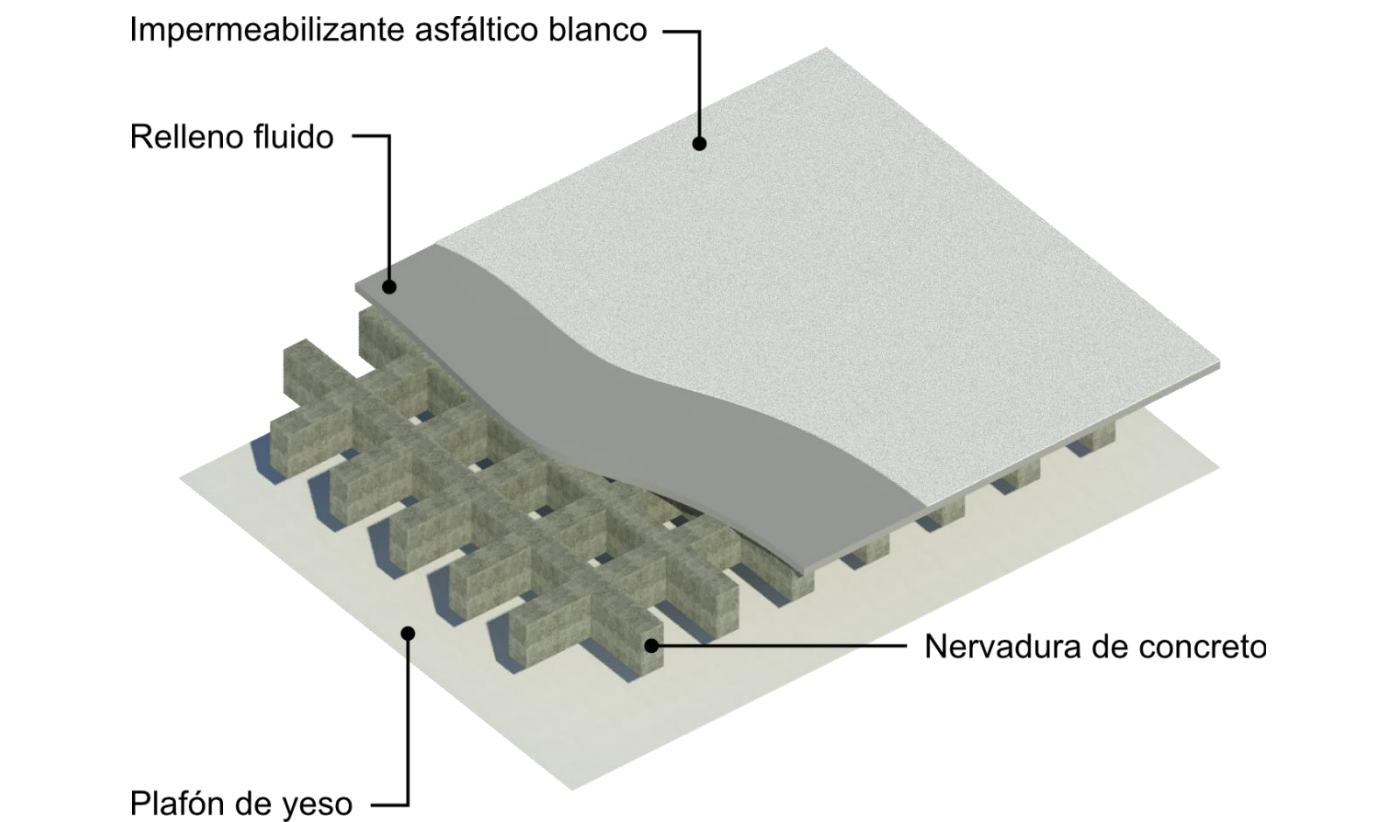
Detalle constructivo de la losa nervada. Elaboración propia.
